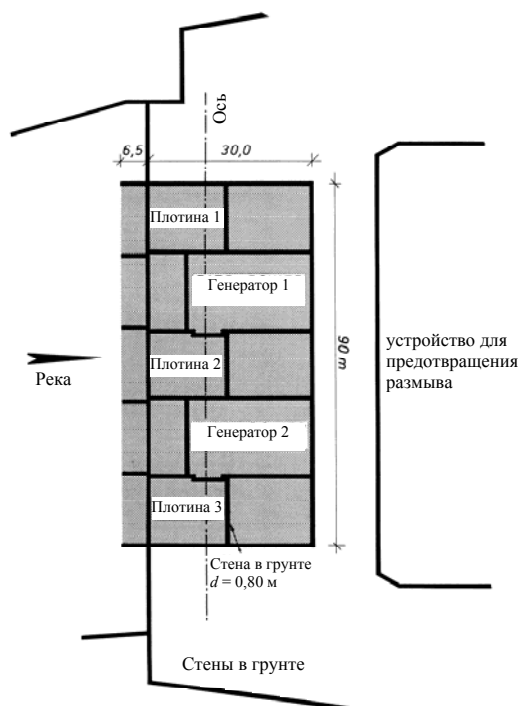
Фрагмент плана электростанции на коробчатом фундаменте со стенами в грунте, заложенном в слое слабых пылевато-глинистых грунтов
